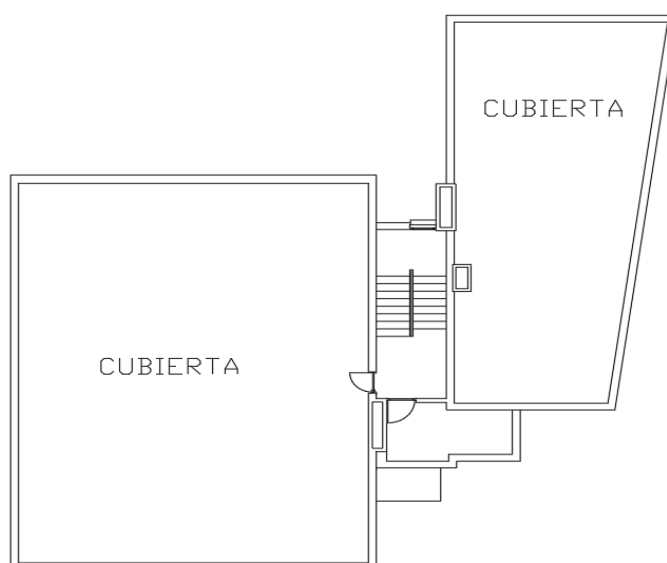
Distribución planta cubierta /2º. Ilustración: Propia.
